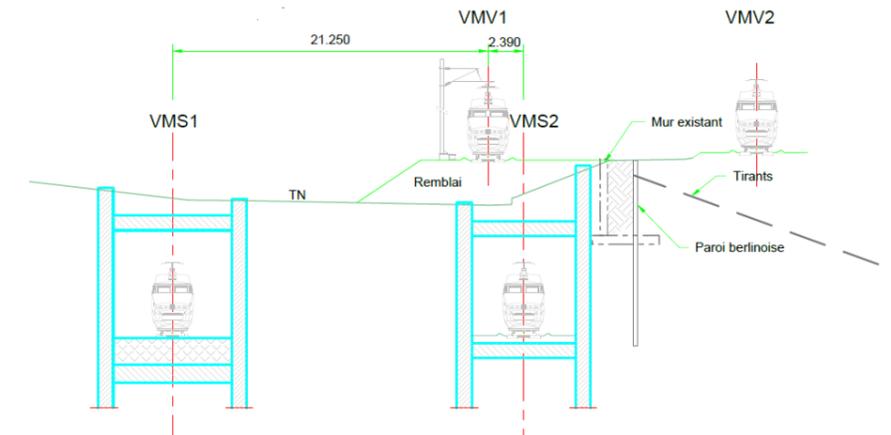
Profil en travers – tranchée couverte (Source :EGIS, 2021)
